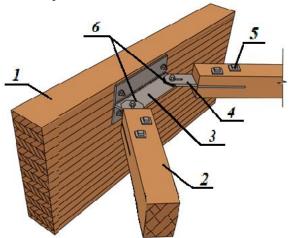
Крепление деревянных раскосов связей с помощью металлических прокладок 1 - основная несущая конструкция, 2 - брусчатый раскос с пропилами на концах, 3 - стальной сварной башмак с горизонтальными полками, 4 - стальные наконечники, вставленные в пропилы раскосов, 5 - сквозные болты с квадратными шайбами со стороны древесины 6 - монтажная сварка после выверки конструкции в проектное положение
